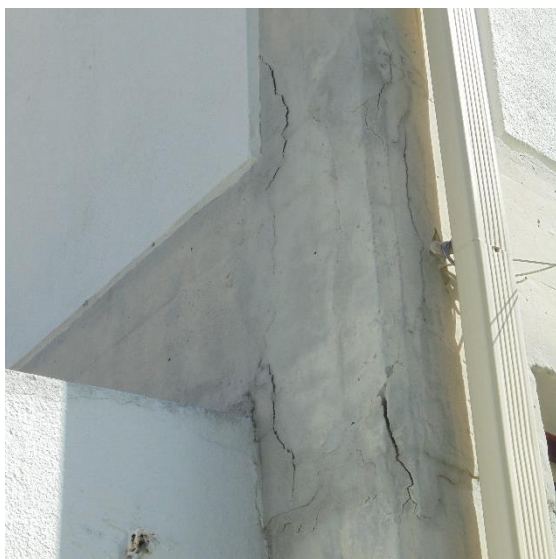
Aspeto de fissuração e empolamento em nó viga/pilar ao nível da laje do piso superior.
